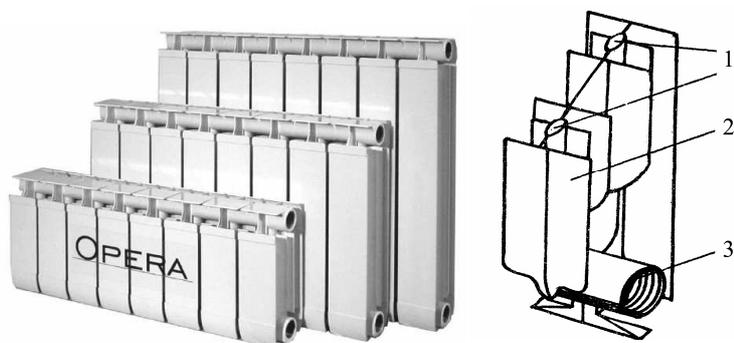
Общий вид литых биметаллических радиаторов: 1 – трубы для прохода теплоносителя; 2 – элемент из алюминиевого сплава; 3 – установка прокладок
